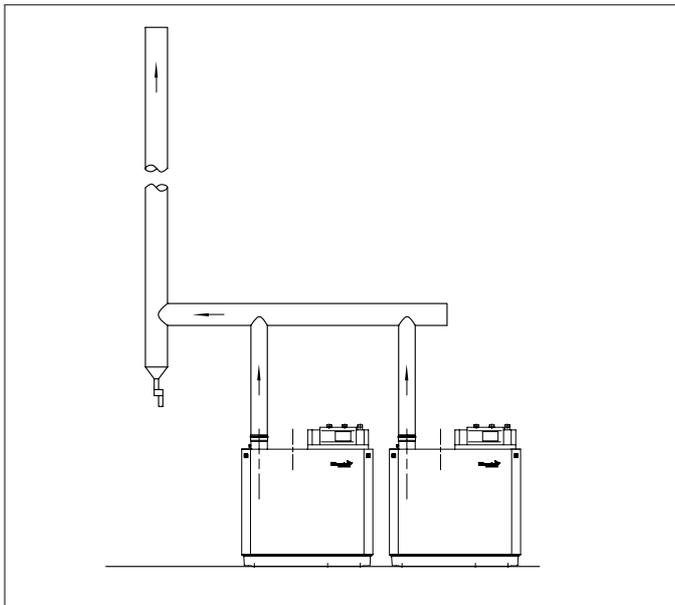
Installation en cascade avec deux chaudières, raccordement sur cheminée
